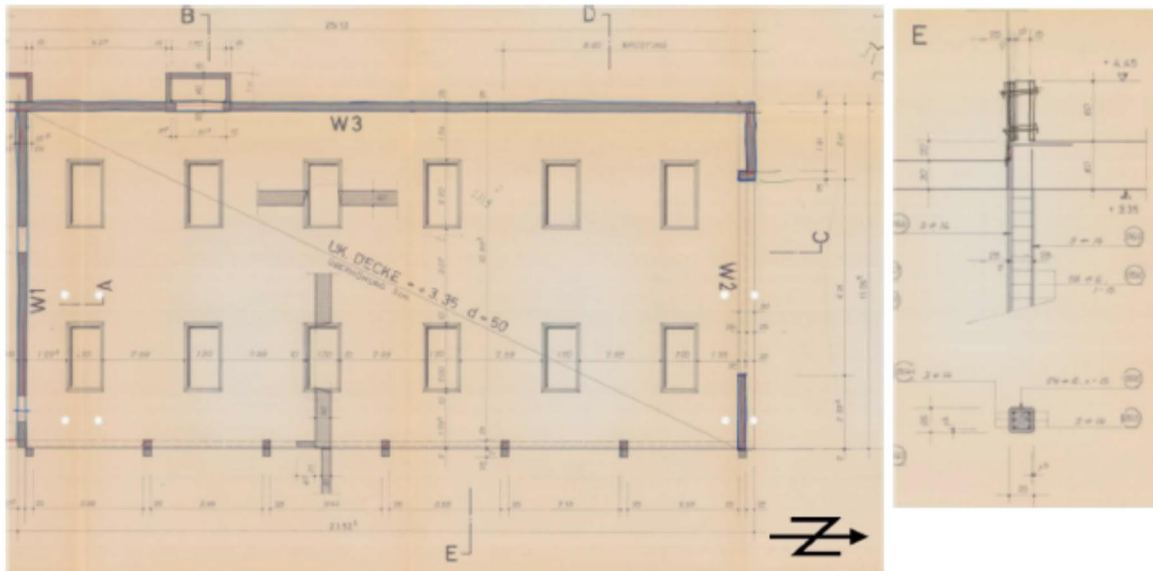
Plan horizontal de la partie 1 du bâtiment examinée « Garage » (à gauche) et détails des piliers (à droite).
